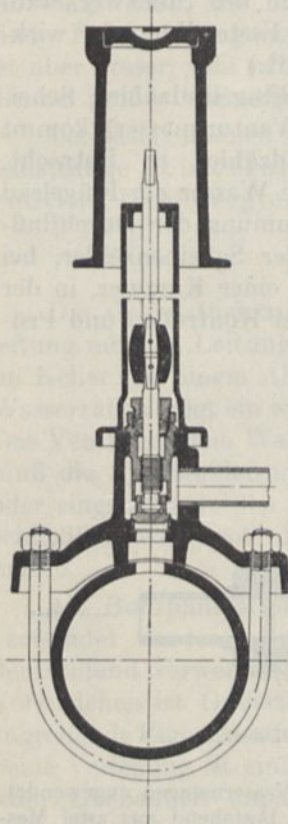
Ventilrohrschelle (für den Anschluß von Grundstücksleitungen an den Straßenstrang).
